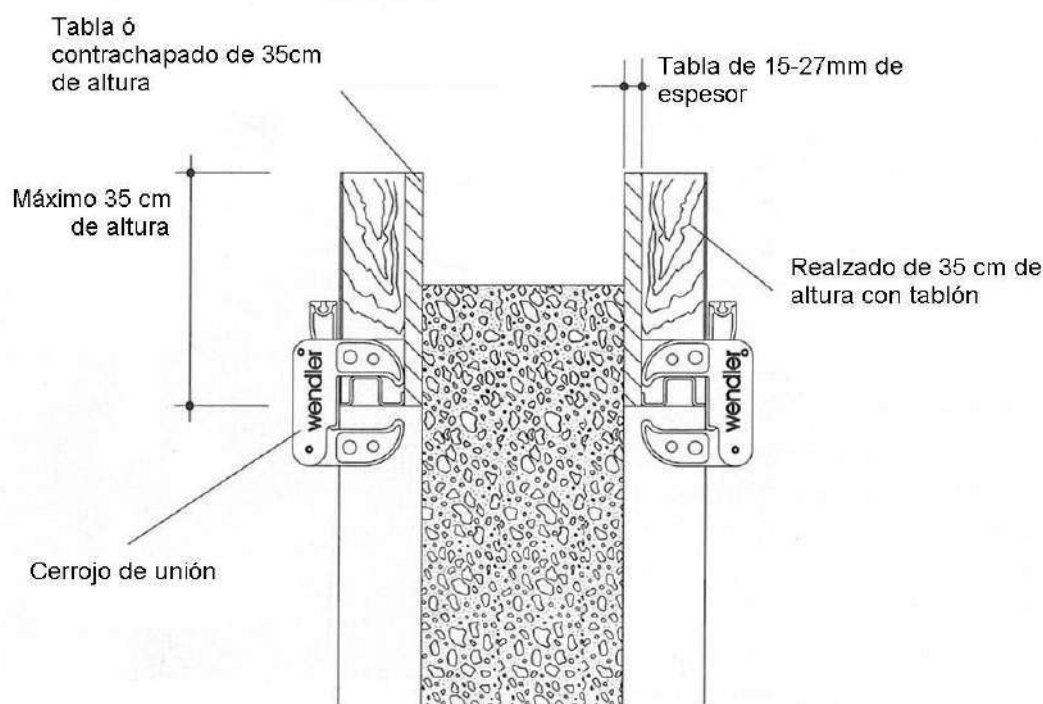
Encofrado de más de 270cm de altura (con pantallas apaisadas ó con retenedor)
